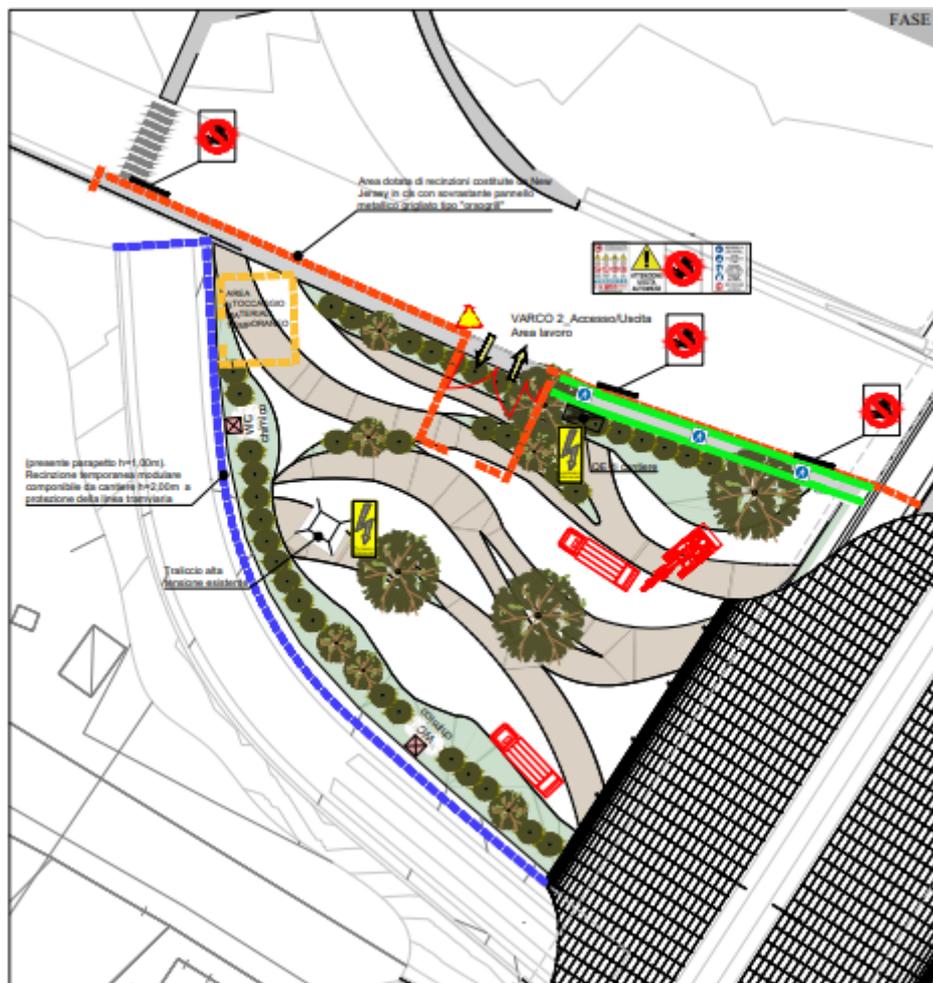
Interventi su aree esterne (Area Ovest Ferrovia)
